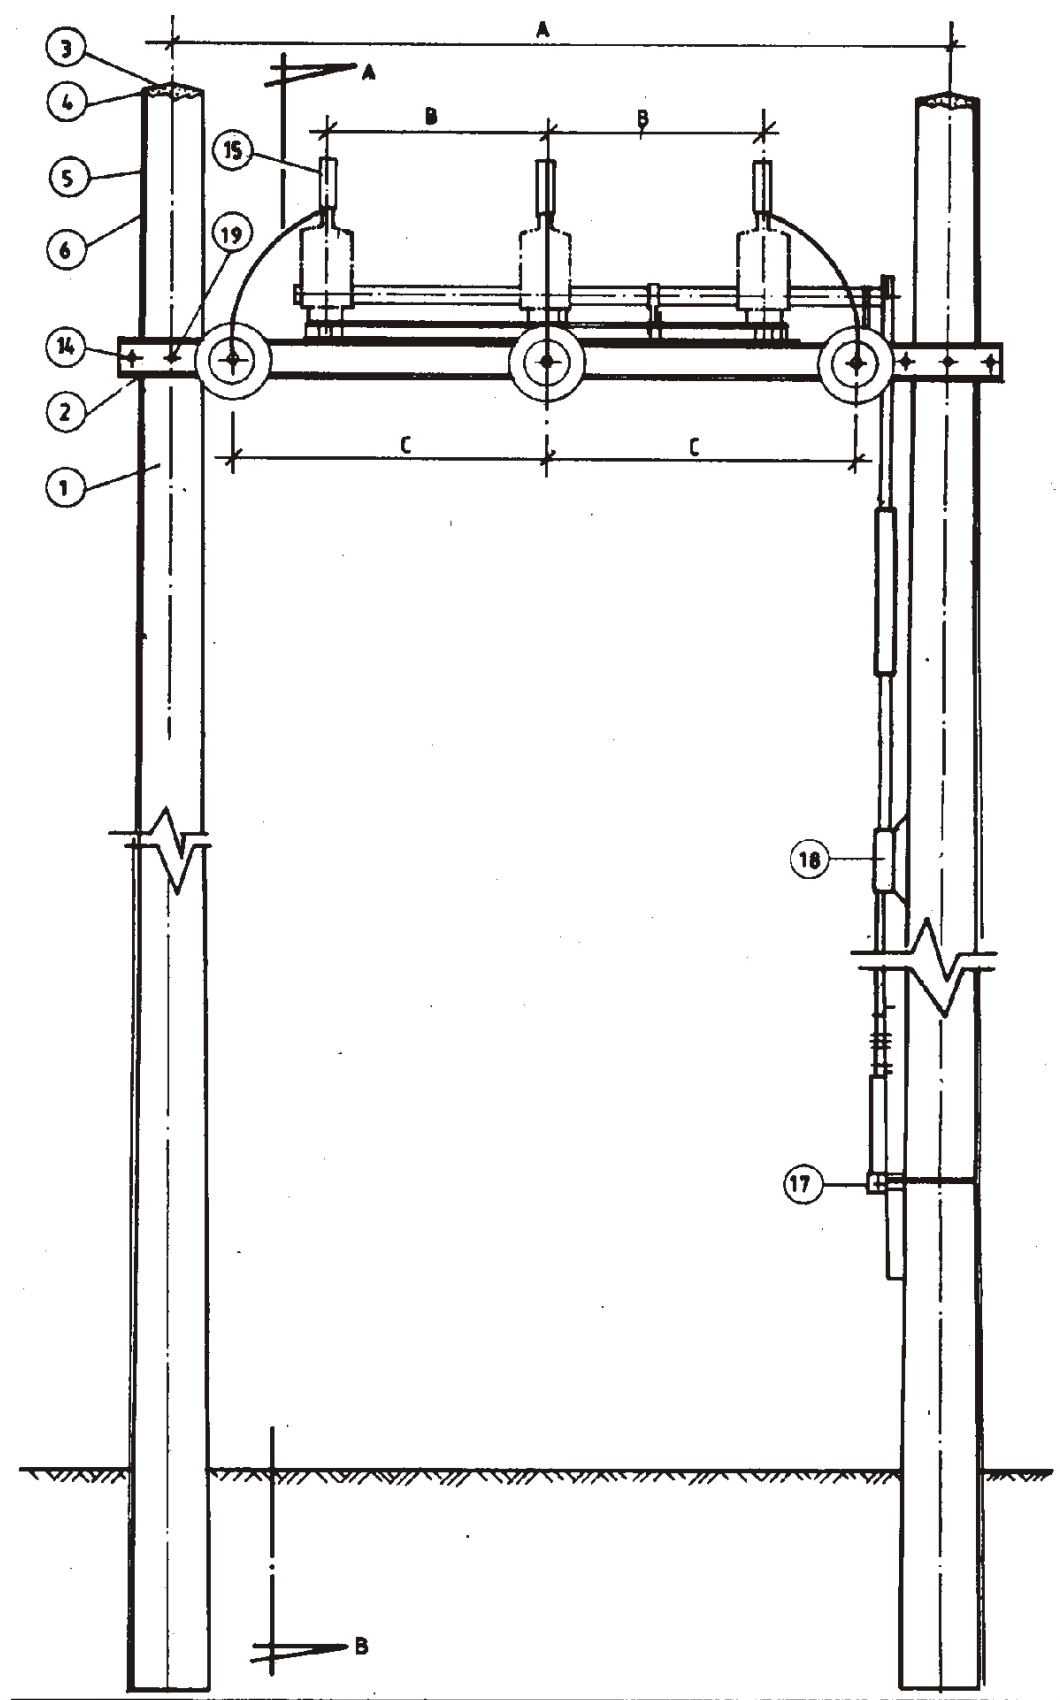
PÓRTICO DE AMARRAÇÃO COM SECCIONADOR - VISTA FRONTAL (EDM, 2006)
